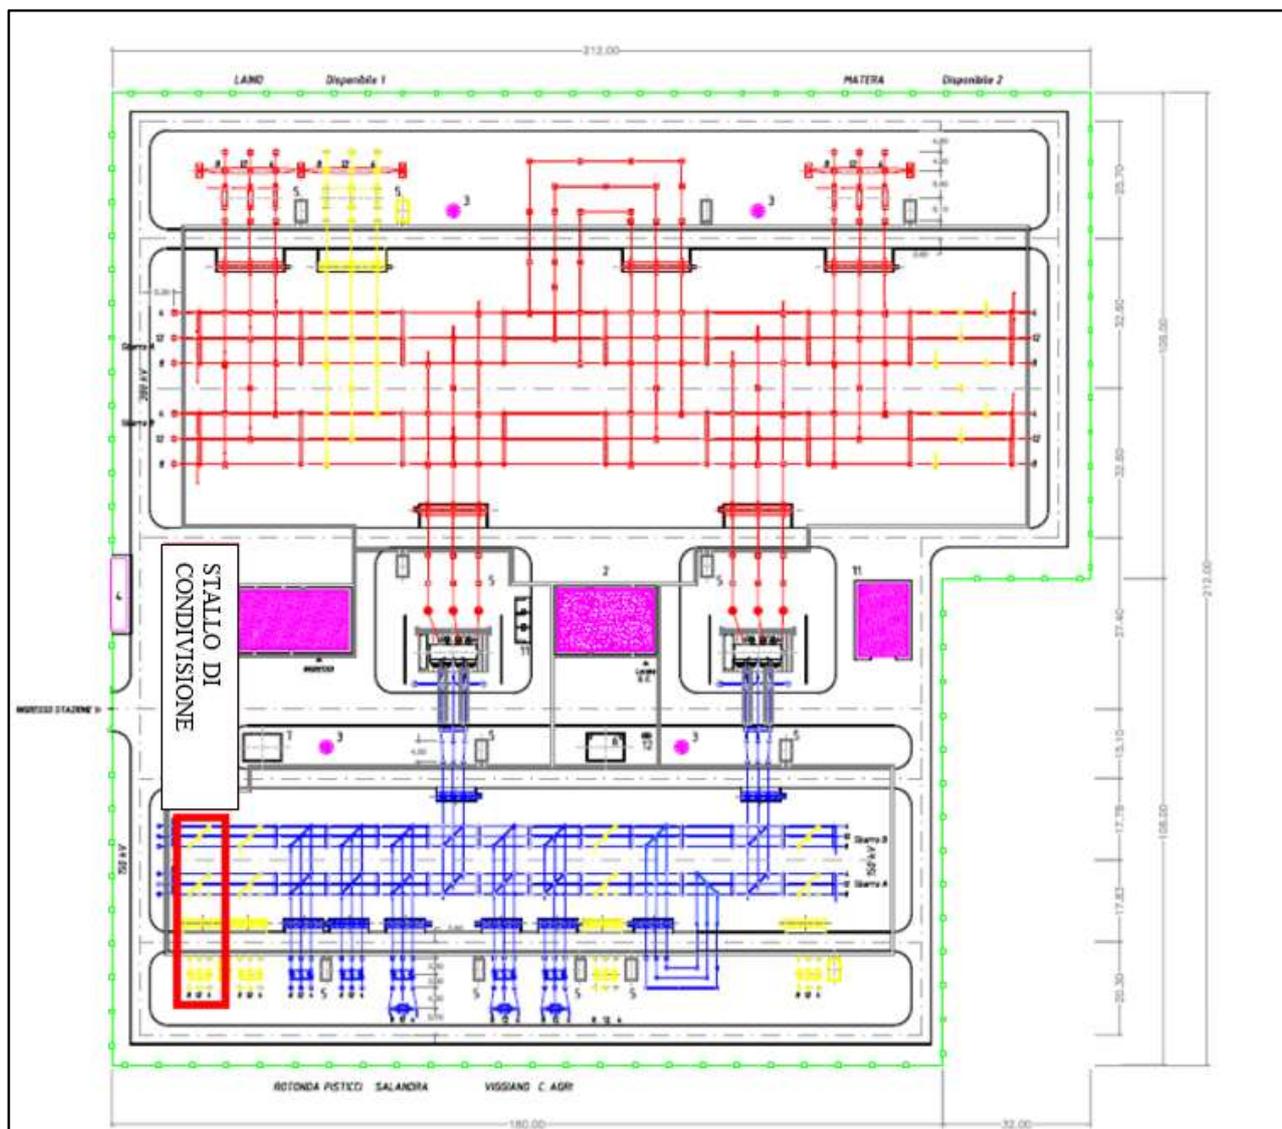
Planimetria della SE RTN a 380/150 kV con l'ubicazione dello stallo condiviso
